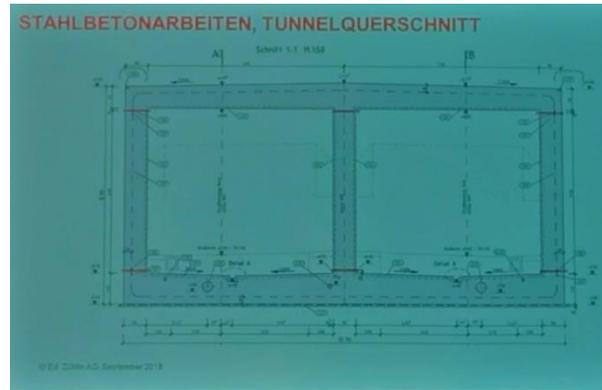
Stahlbetonrechteckquerschnitt des Tunnels
